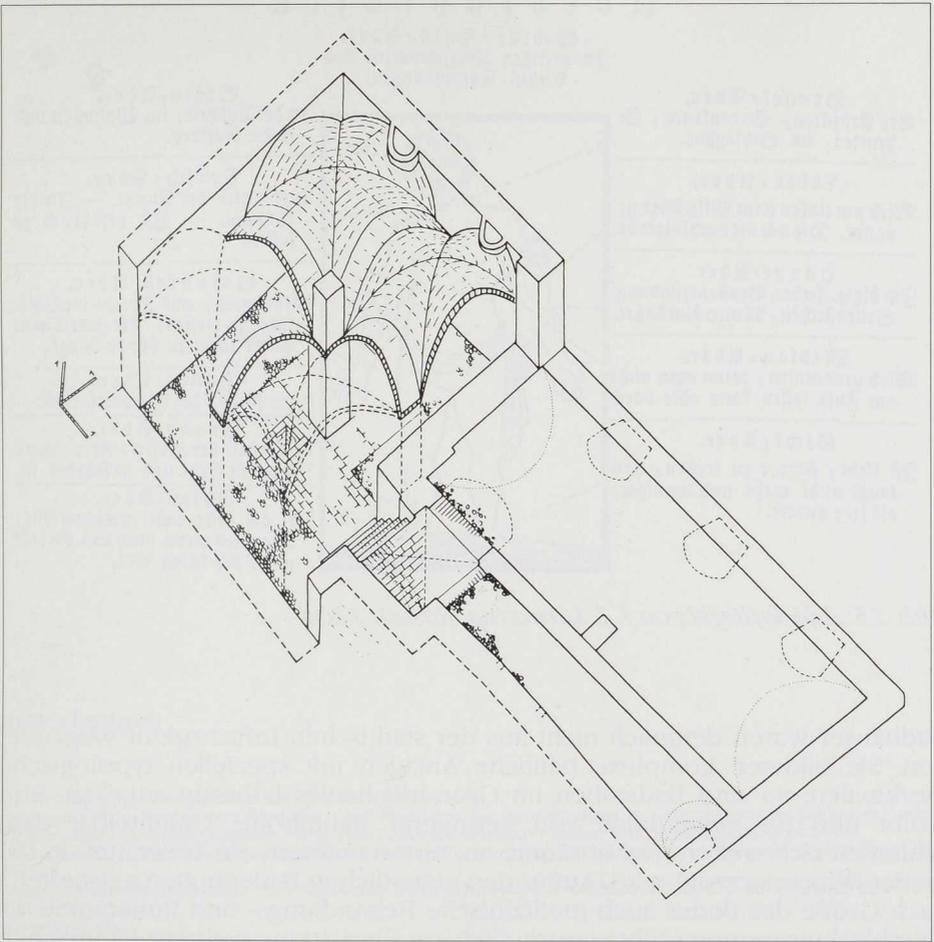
Ravensburg, Stadelgasse 1, isometrische Darstellung des Untergeschosses. Die Isometrie veranschaulicht den Einstützenraum im Untergeschoß mit den unterschiedlichen Pflasterungen.
